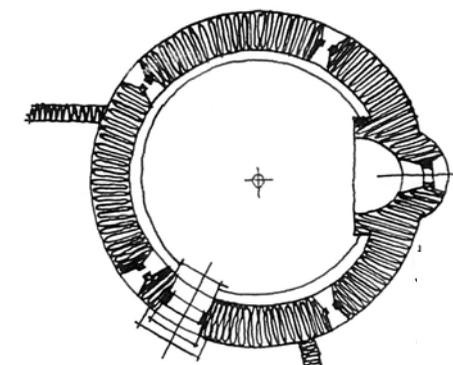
Grundrisse des Karners Hardegg, M 1:200. Planarchiv des Bundesdenkmalamtes Wien
